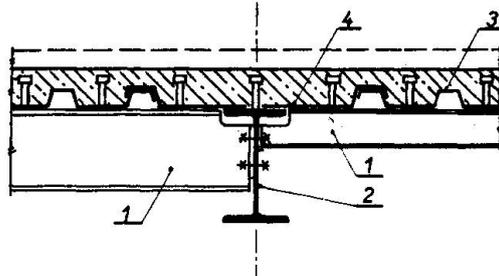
Ortbetonverbunddecken des Baukastensystems VIP (1-Deckenträger, 2-Unterzug, 3-Stahlzellenpaneele, 4-Blechelemente)
